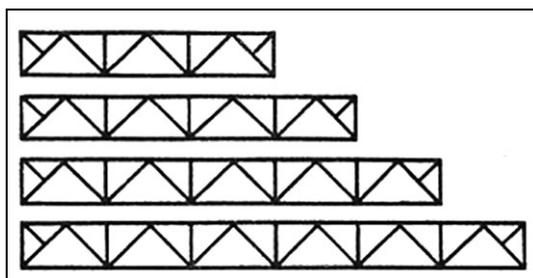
Схемы стальных унифицированных ферм с параллельными поясами
